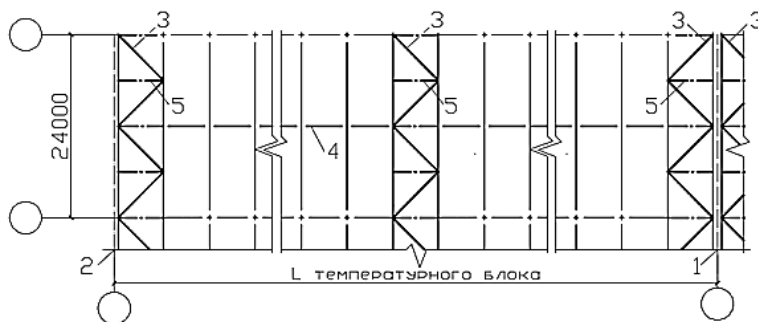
Схема расположения горизонтальных связей 2-го типа по нижним поясам стропильных ферм пролётом 26 м и шагом 6 м:
